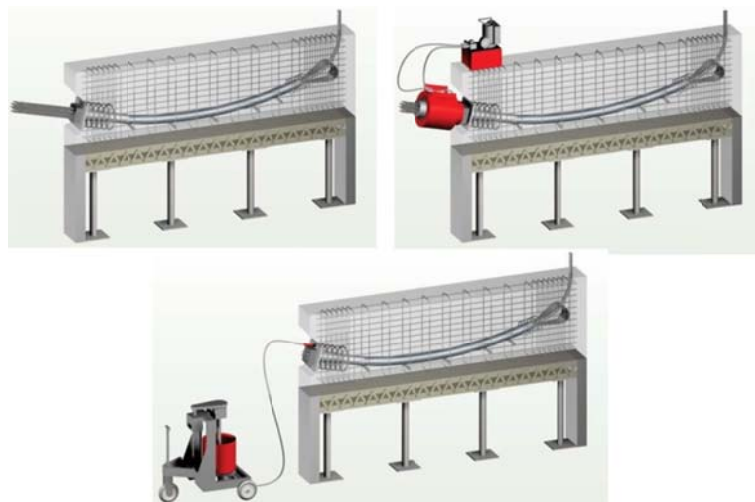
Posicionamento do cabo e concretagem da peça, aplicação da protensão, injeção da pasta de cimento – protensão com aderência posterior (RUDLOFF)
